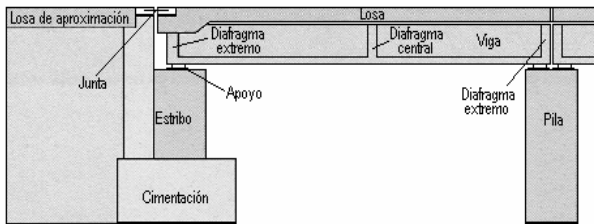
Elementos que forman la subestructura y superestructura de un puente
